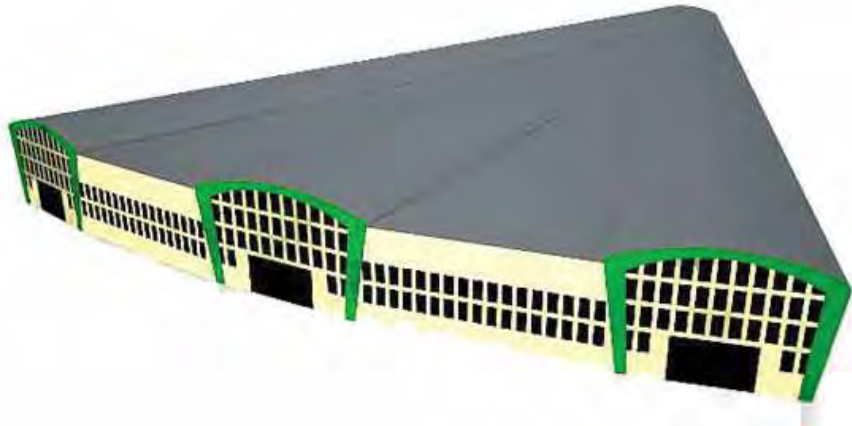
Imagem em 3D da vista área do Mercado da Lapa
